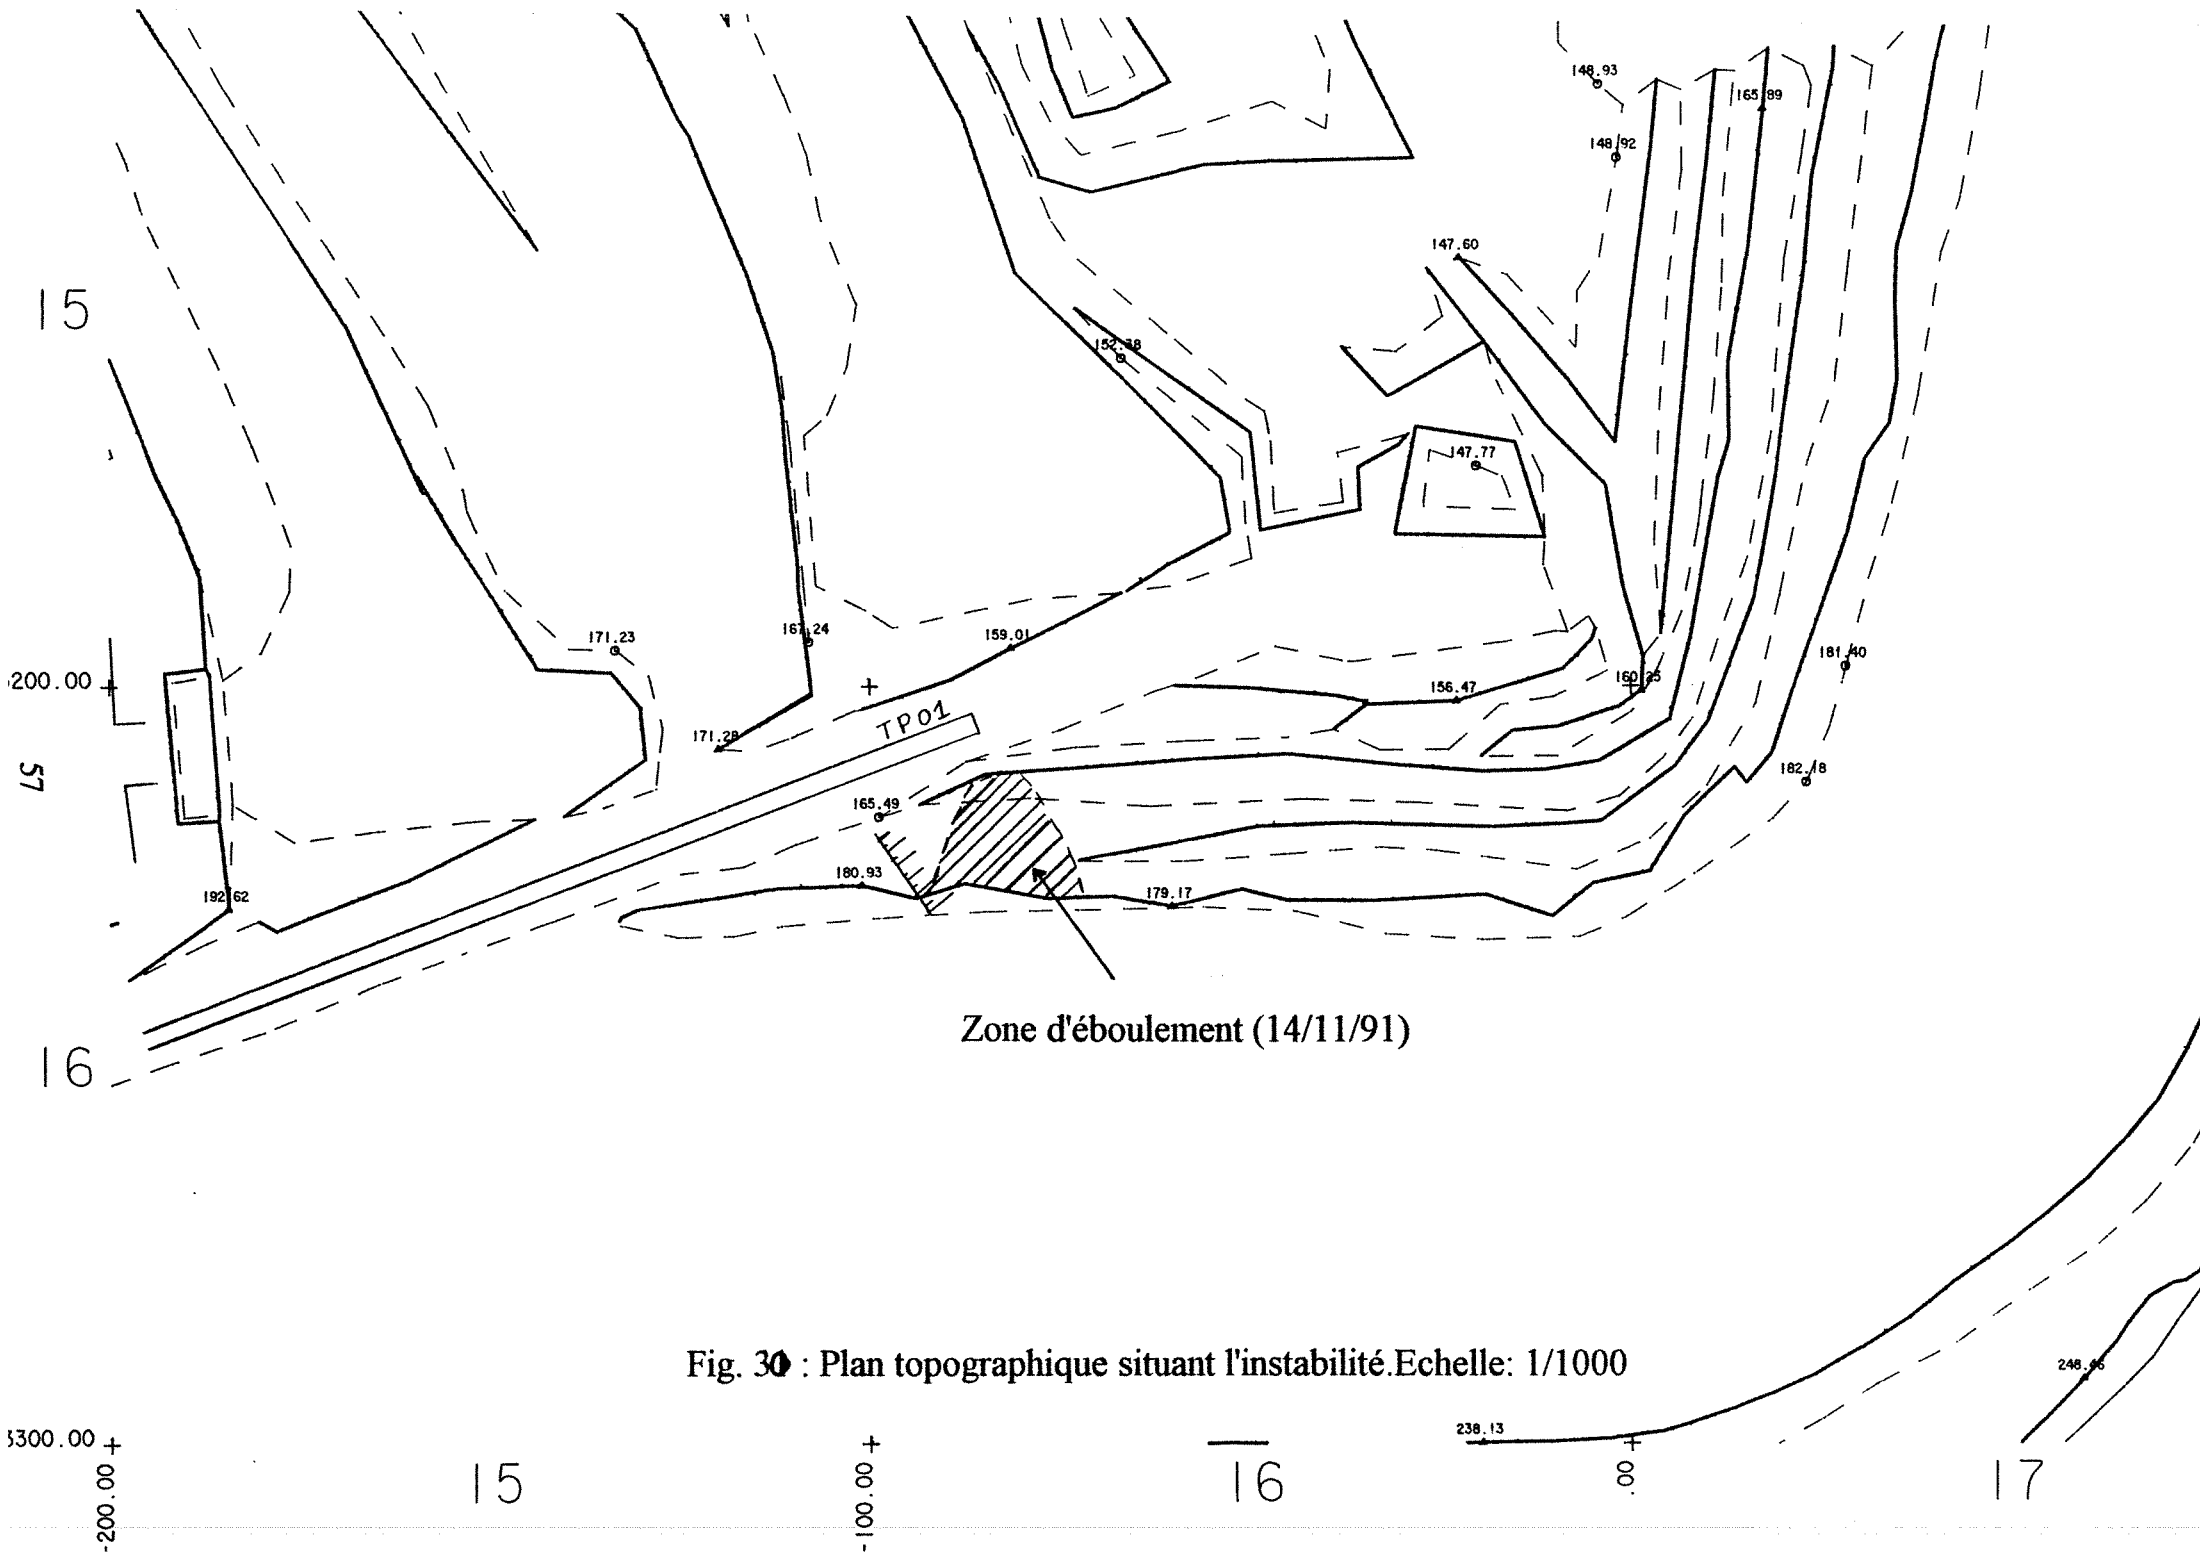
Plan topographique situant l'instabilité. Echelle: 1/1000
